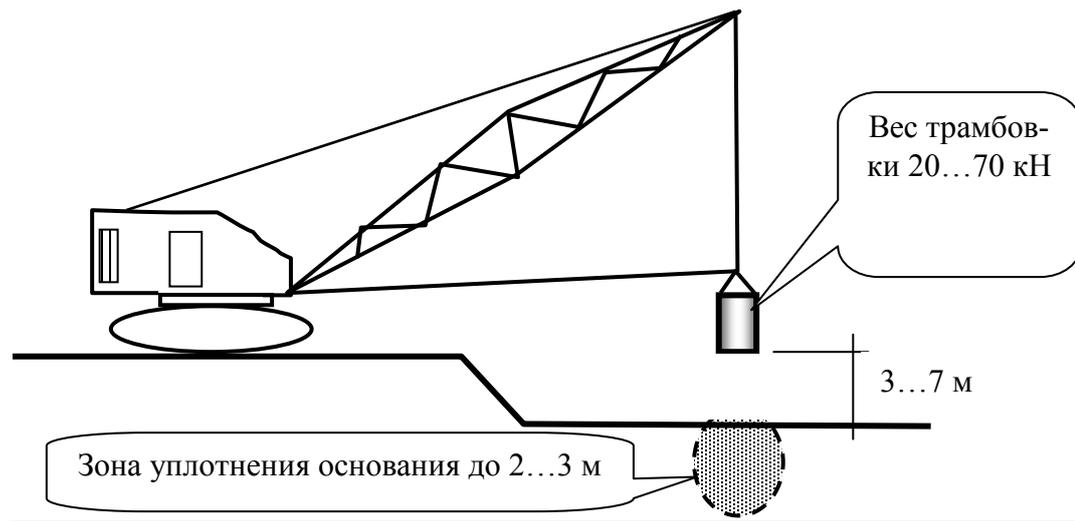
Схема поверхностного уплотнения грунта тяжелыми трамбовками
